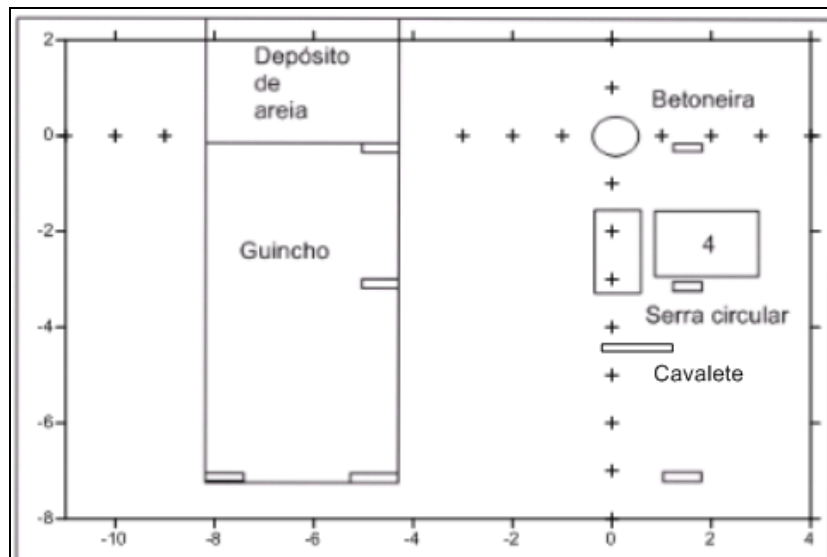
Layout* do canteiro com os pontos medidos da betoneira, unidade em metros.
